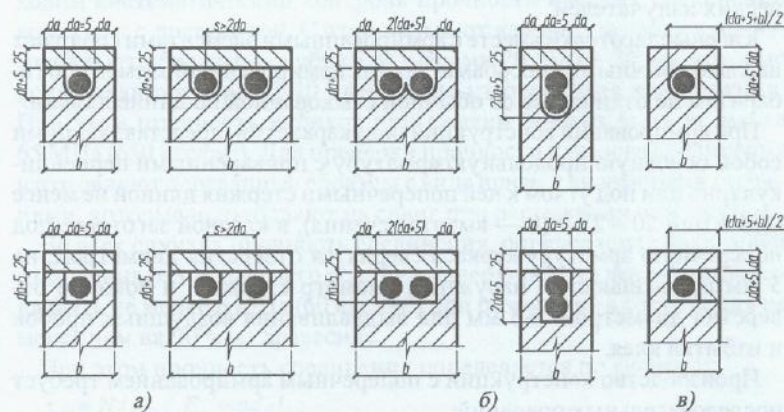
Размещение пазов полукруглого и прямоугольного очертания по ширине сечения: а — обычным способом; б — групповым способом; в — при вклеивании стержня по боковой поверхности
